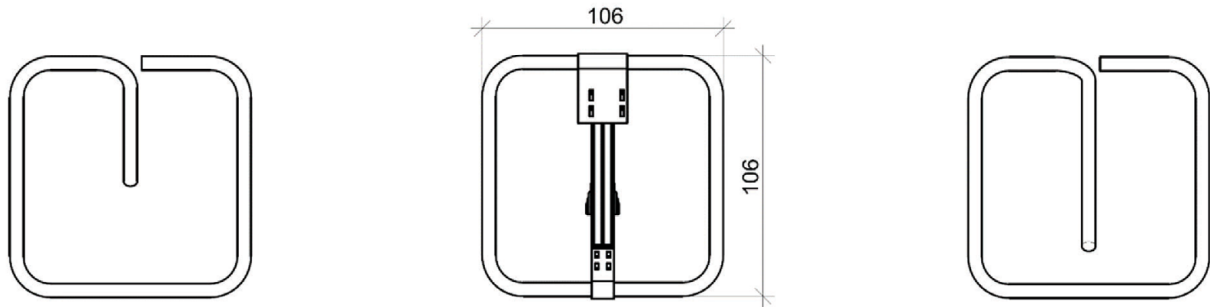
Schöck Isokorb® Typ K mit CCE mit integrierter Vertikalbewehrung gem. Abschnitt D.1.1 und Sonderbügel
